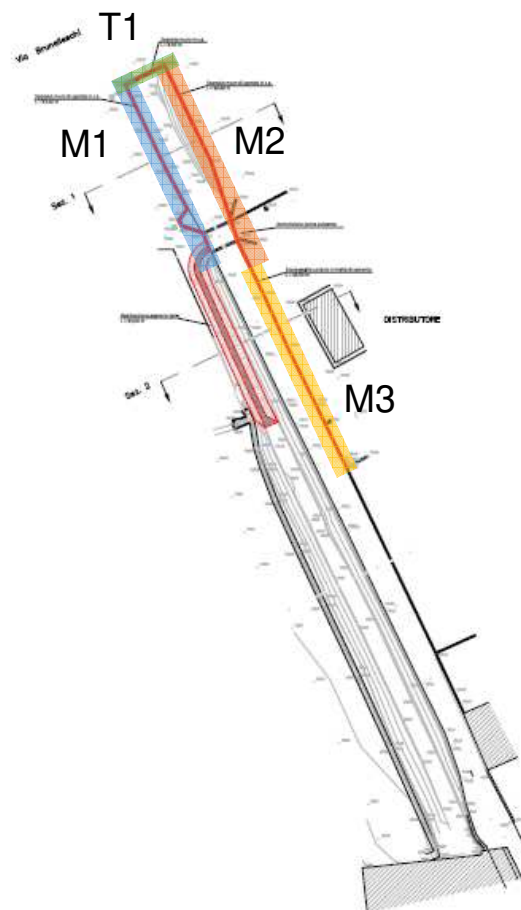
Pianta di sovrapposizione (SITO 2):muro spondale M1 (azzurro), muro spondale M2 (arancio), muro spondale M3 (giallo), trave parapetto T1 (verde).
